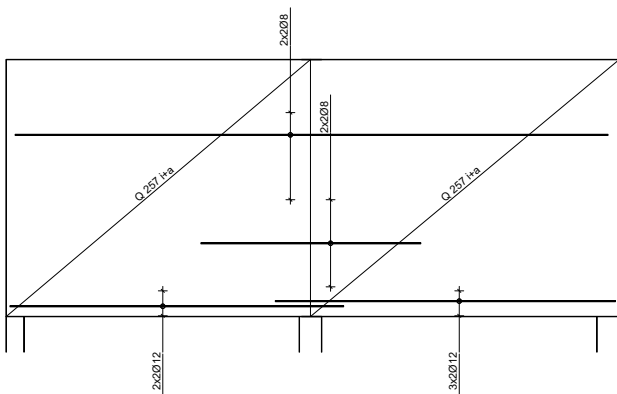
Bewehrungswahl im BauStatik-Modul S360.de
